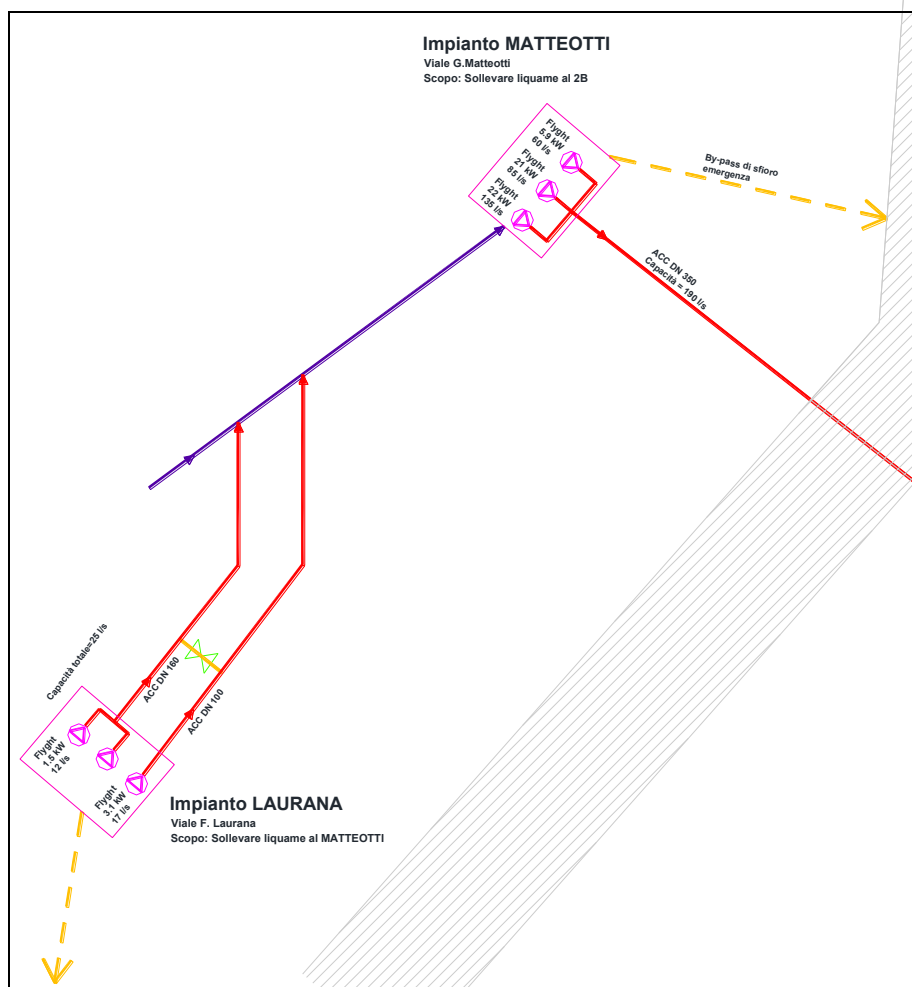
Schema impiantistico del sollevamenti presenti nella zona Isola
